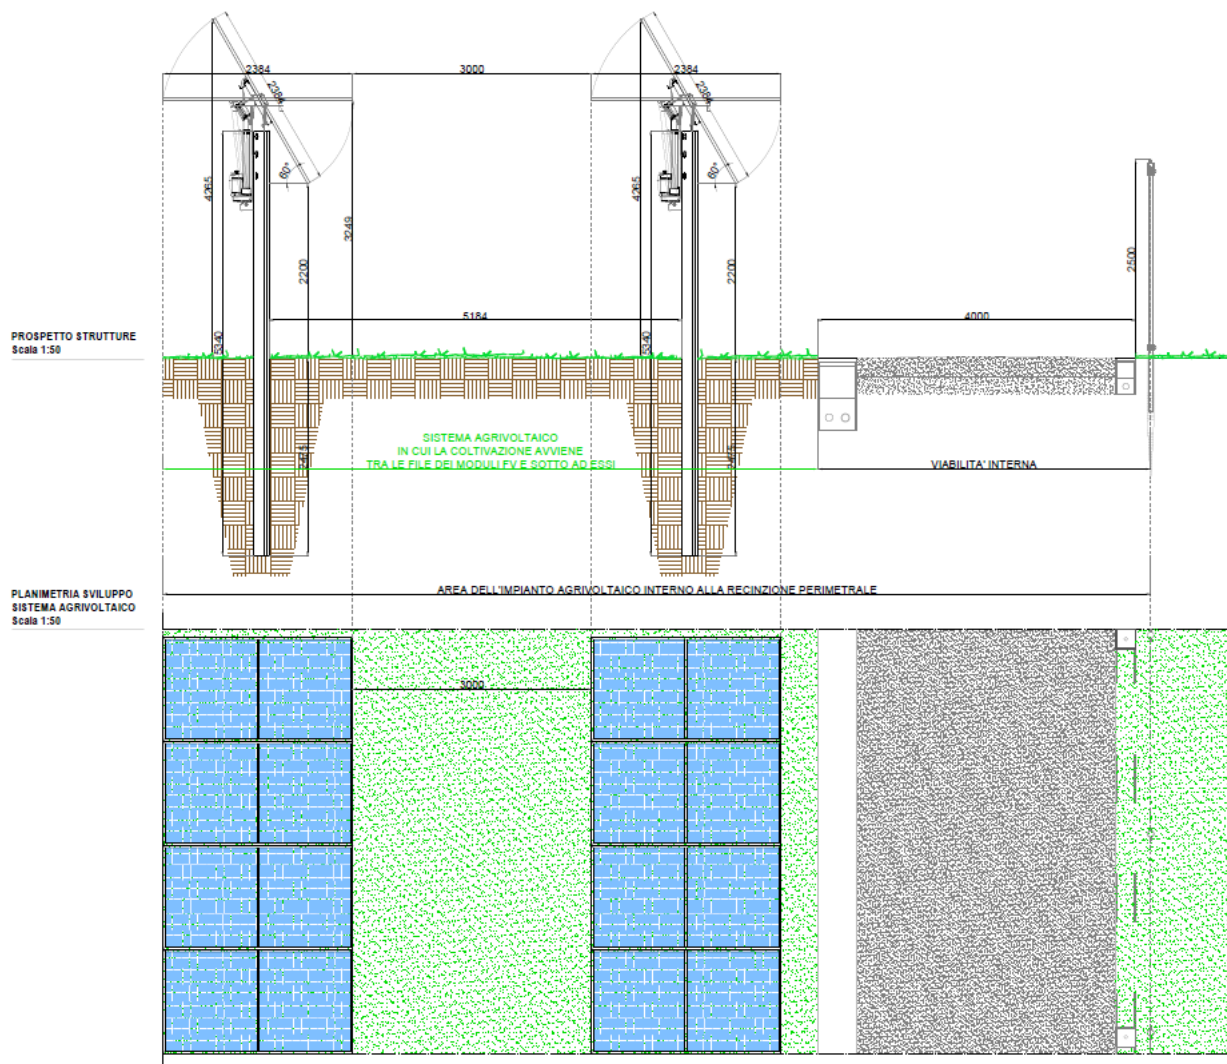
particolari strutture – viste laterali e vista dall'alto stringa
